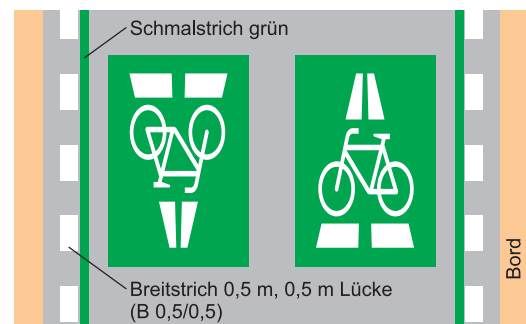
Prinzipskizze der Markierung einer Fahrradstraße auf einer Radschnellverbindung
